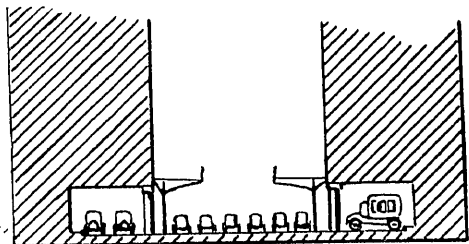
ª Proyecto de calle con galerías para estacionamiento de vehículos y aceras elevadas.
